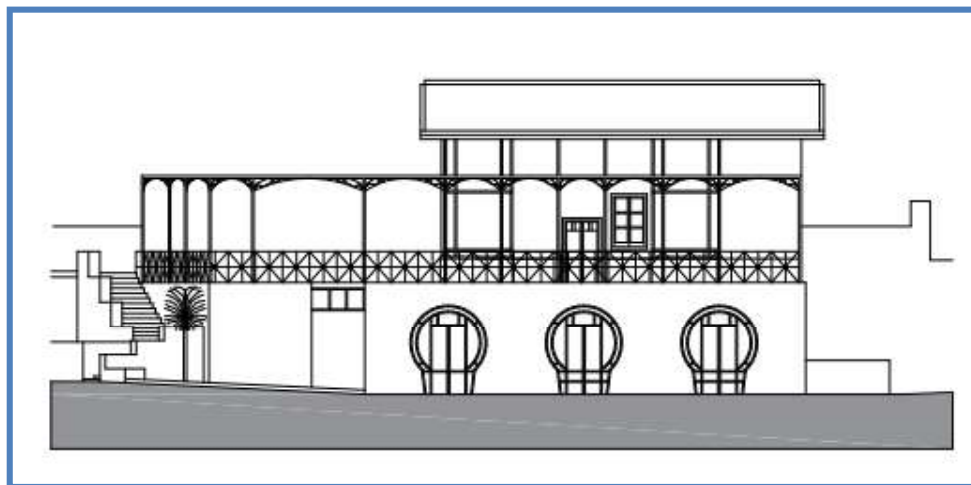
fabbricato ex inalazioni - PROSPETTO NORD-EST
